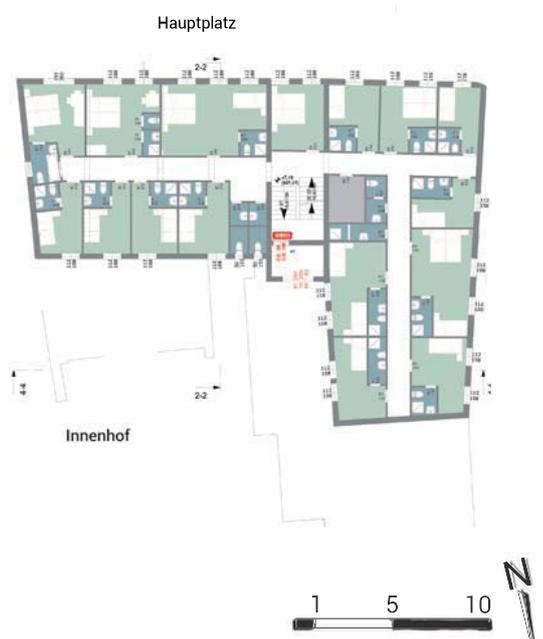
Grundriss 2. Obergeschoss Hotel zur Sonne
